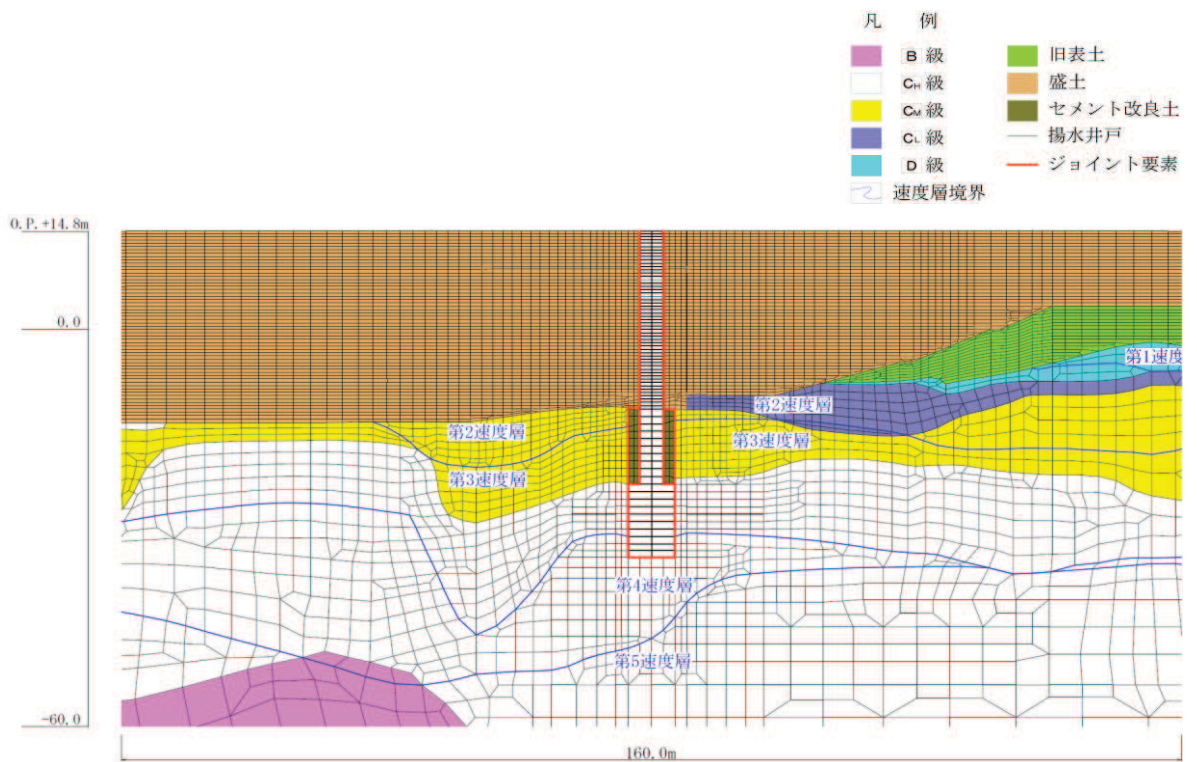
(4) ジョイント要素の配置図 (No.4 揚水井戸)
